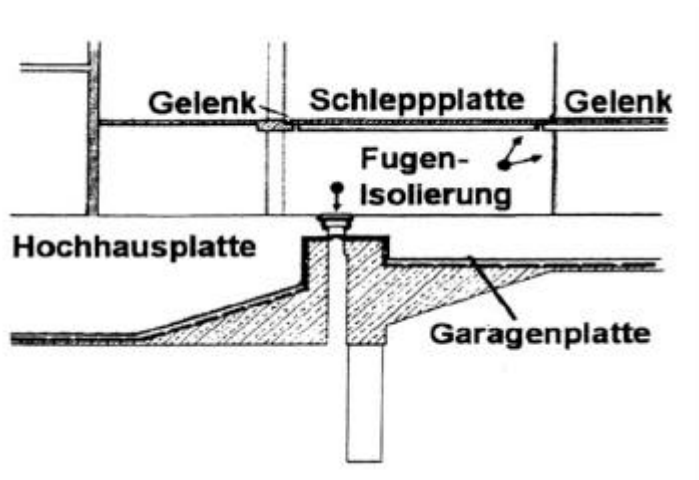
Druckwasserdichte Setzungs- und Fugenisolierung zwischen einer Hochhausfundamentenplatte und dem angrenzenden Flachbau [Phocas 2001, S. 88]
